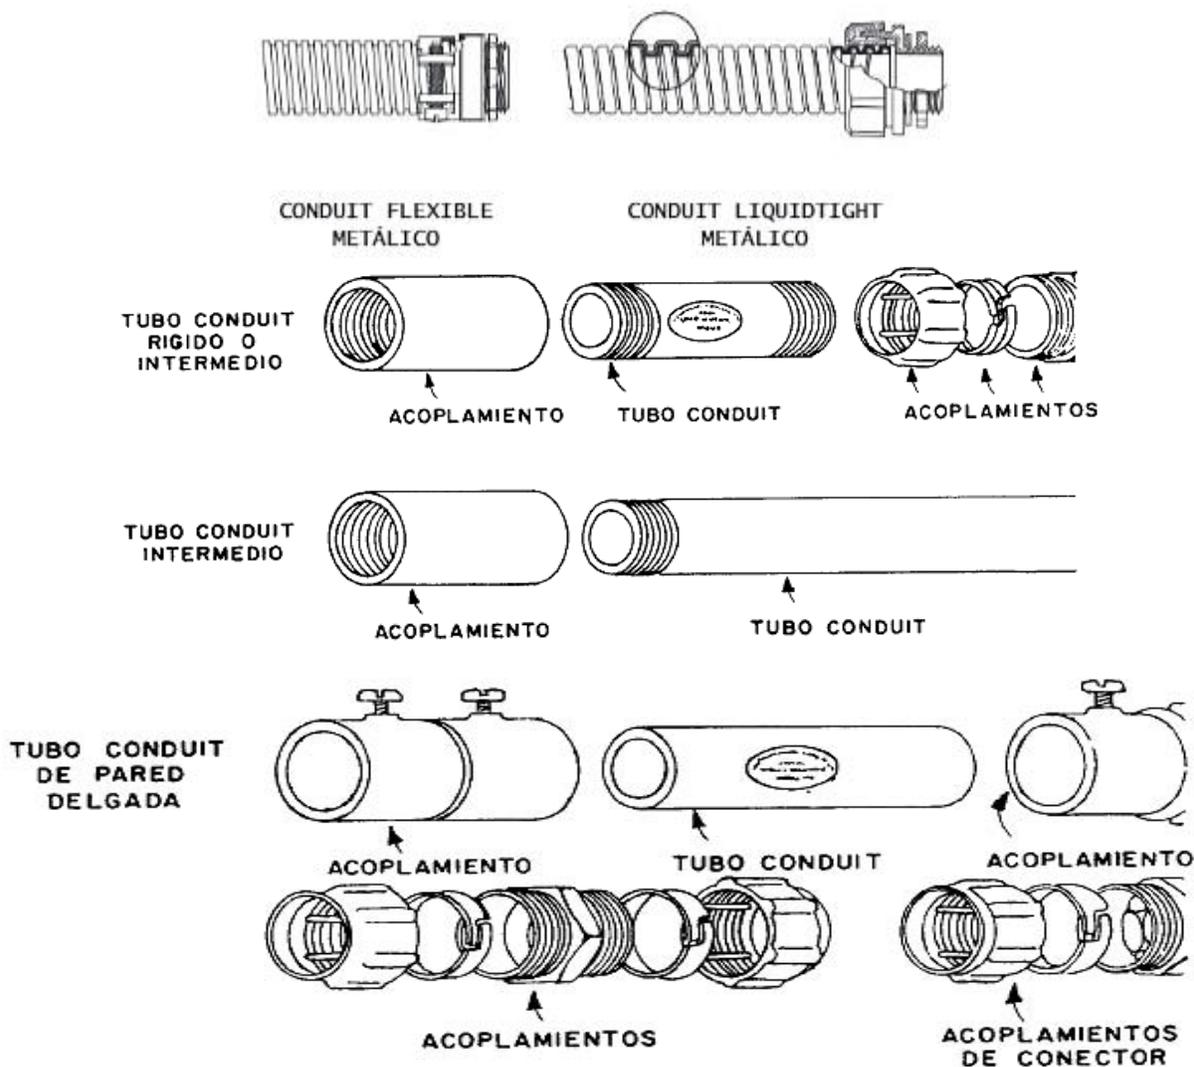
Algunos tipos de tuberías y conectores Conduit. [10]
